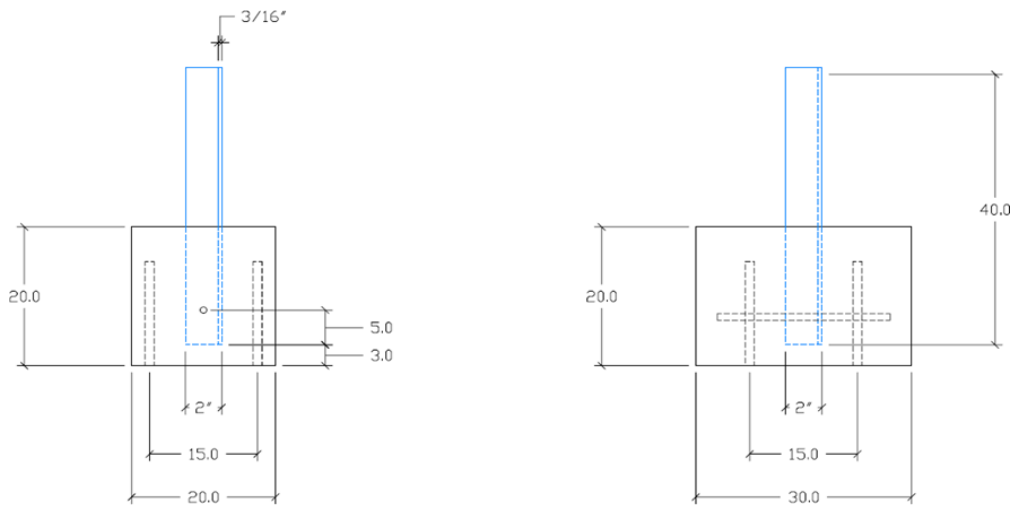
Dado de cimentación. Cubierta en azotea.
